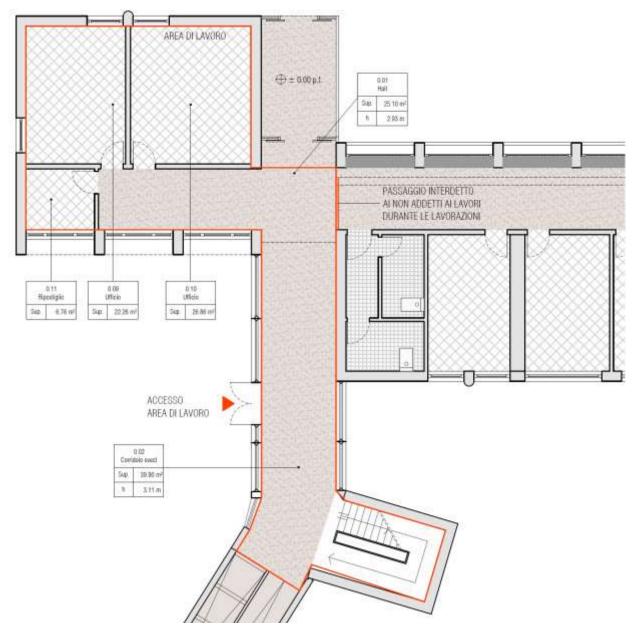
Particolare area di cantiere lotto 1 - piano terra
